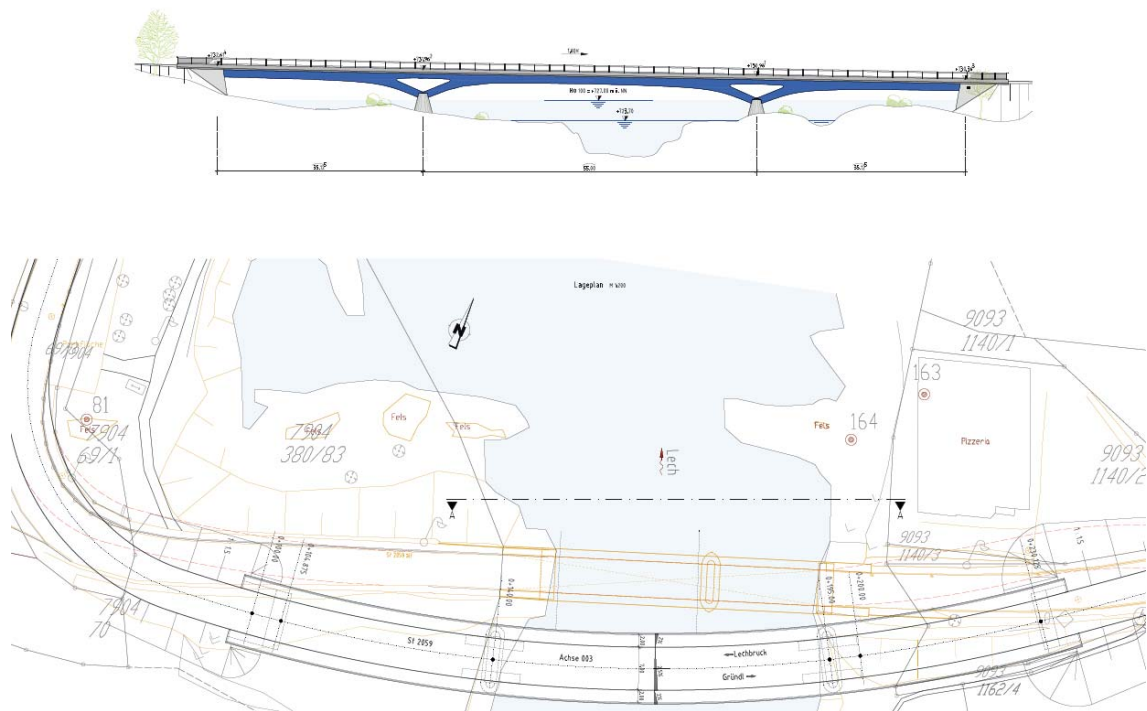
Variante 4 in Grundriss und Ansicht
